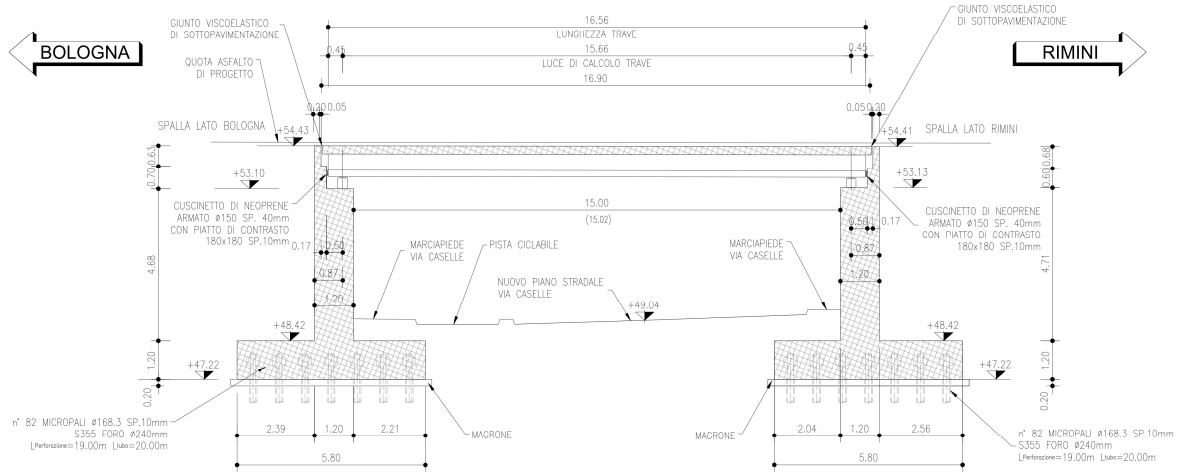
Sezioni trasversali sulle spalle
